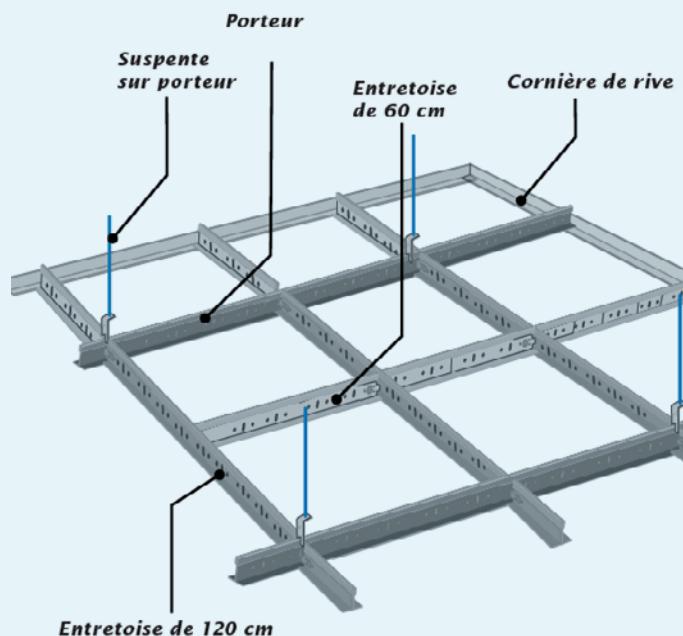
Schéma explicatif de l'ossature métallique. Source : Calepin de chantier de UMPI-FFF
